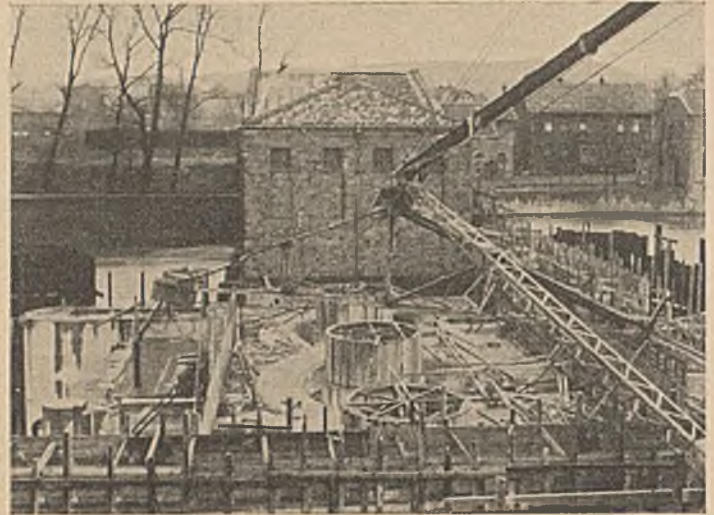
Krafthausbaustelle. Schalung der Einlaufspiralen. Bewehrung der oberwasserseitigen Längswand, die zugleich als Kranbahnträger dient. Betonieren der Spiralenwandungen.
